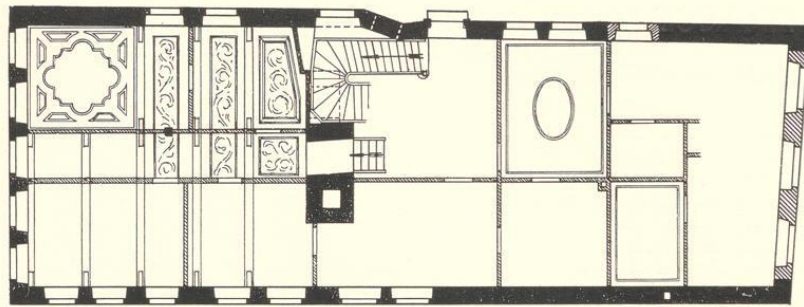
Grundriß des Erdgeschosses des Hauses Ägidistraße 60. Norden oben; Maßstab 1 : 200
